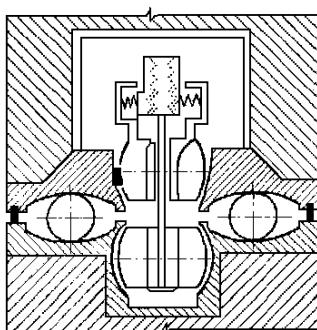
Общий вид конструкции сейсмоизолирующего фундамента с катковыми опорами
